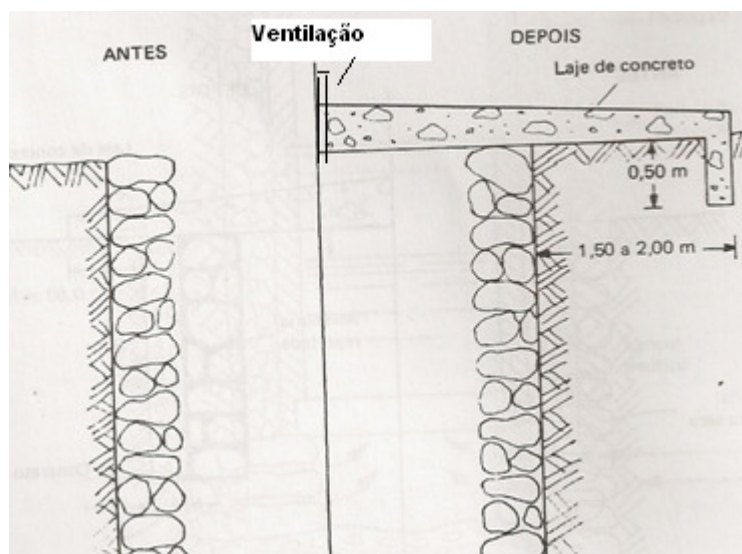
Melhoria do poço, com laje de cobertura ampla, contornada por batente de 0,50m.
